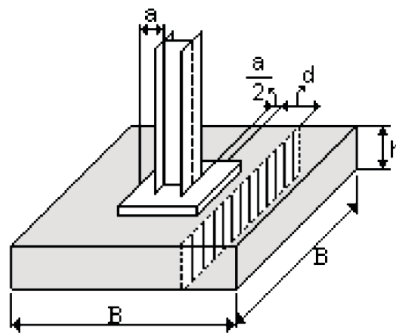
D CORTANTE UNIDIRECCIONAL EN ZAPATA QUE SOPORTA COLUMNA METÁLICA
